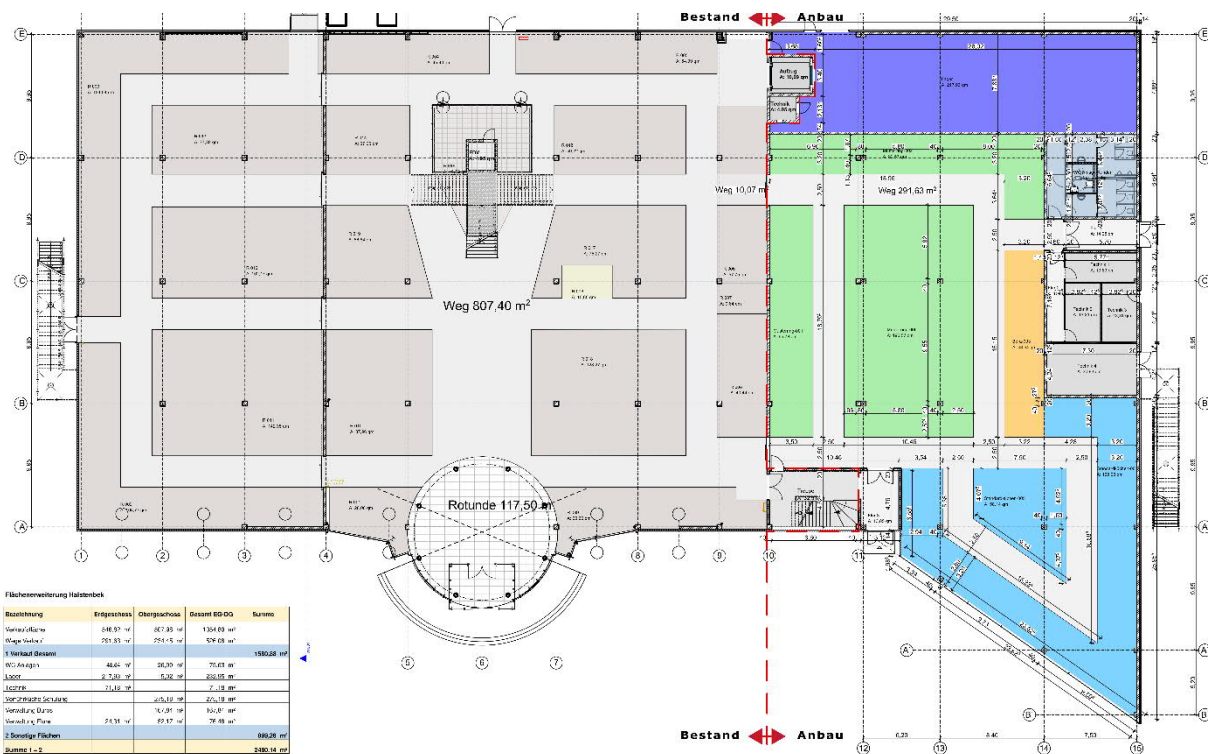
Grundriss EG mit Erweiterung rechts
